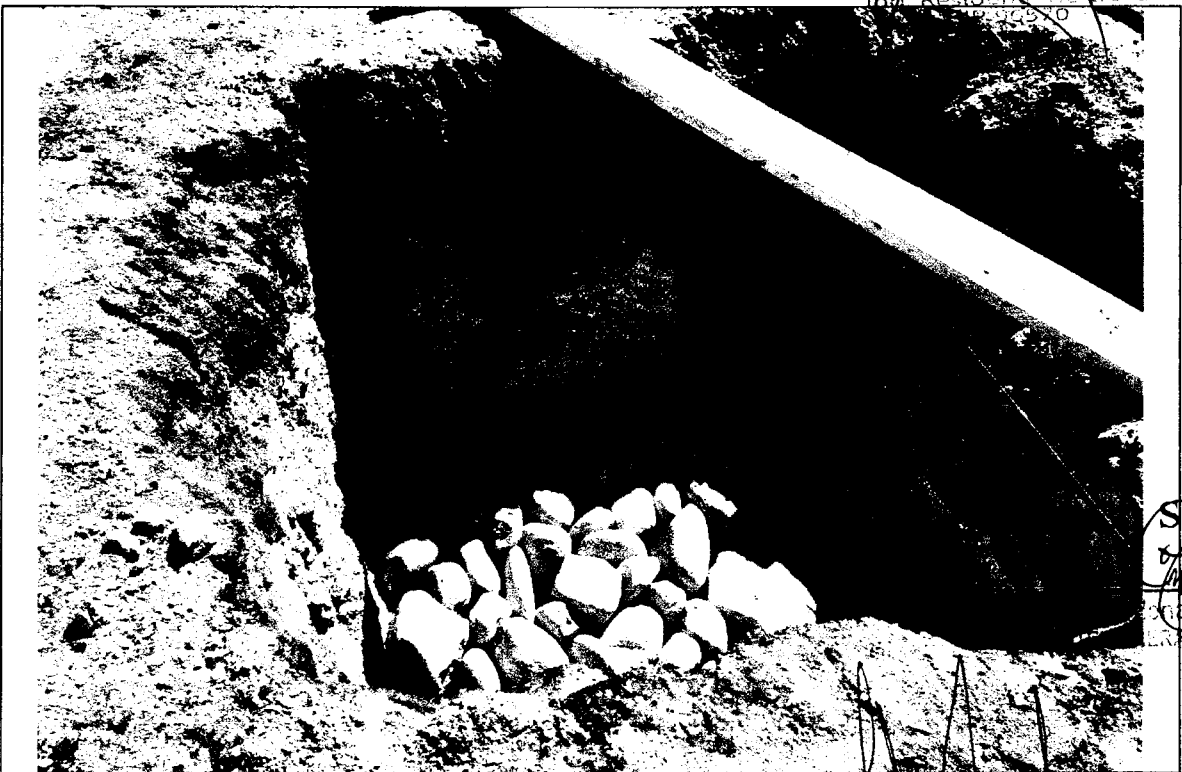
COLOCACION DE PIEDRA GRANDE EN SUB-ZAPATAS.
